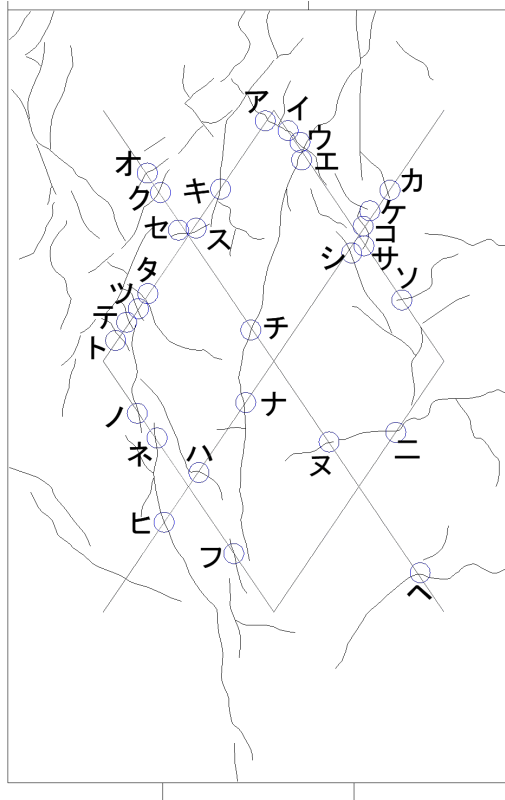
3. 246 パイルキャップひび割れ幅測定位置 (試験体 C-2 負荷荷)
